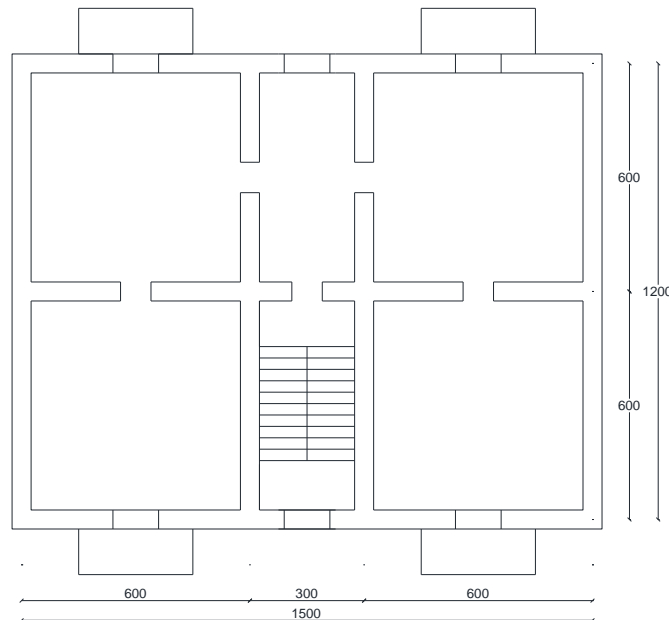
Pianta primo piano dell'Unità Strutturale di base
